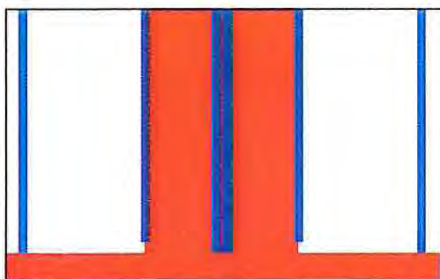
Detalle n°1, elevación eje A, columnas desvinculadas.
